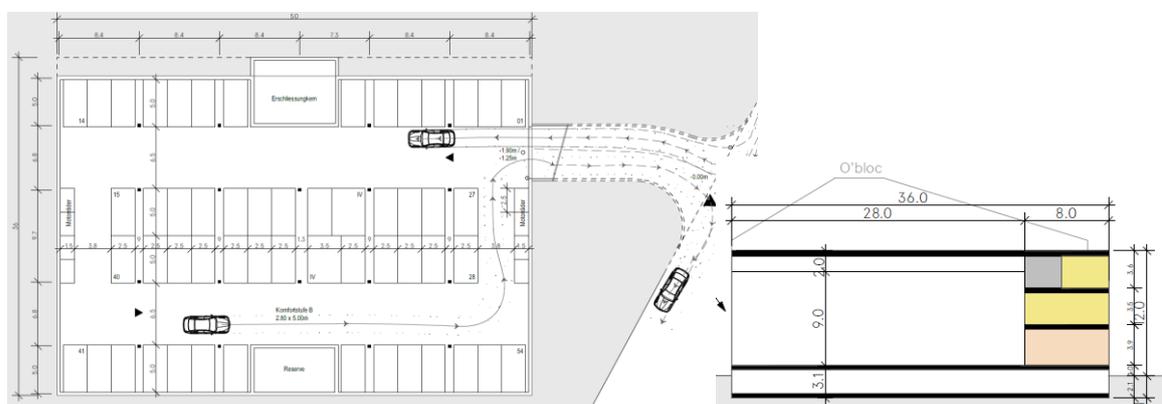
Option Einstellhalle (Grundriss und Querschnitt)
